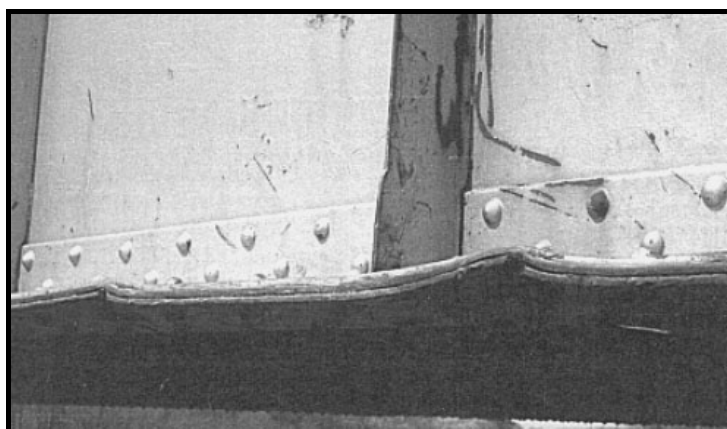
Banzo inferior de uma viga danificado por colisão de veículo [19]
